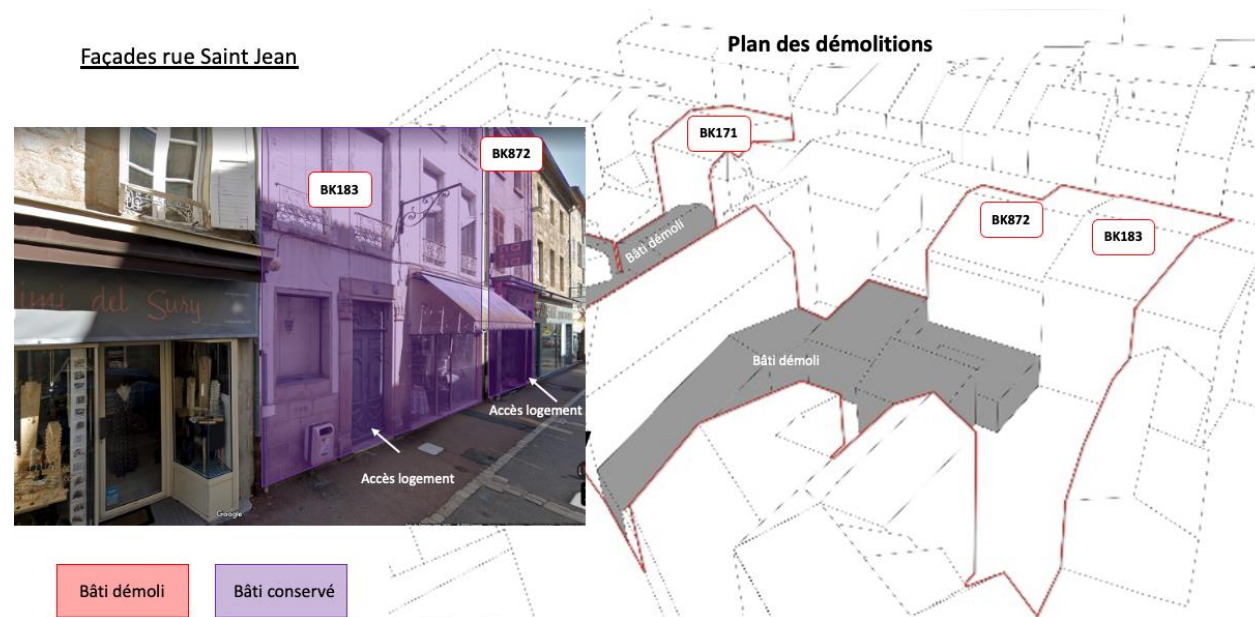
Repérage des façades conservées sur la rue Saint-Jean - 1/2
